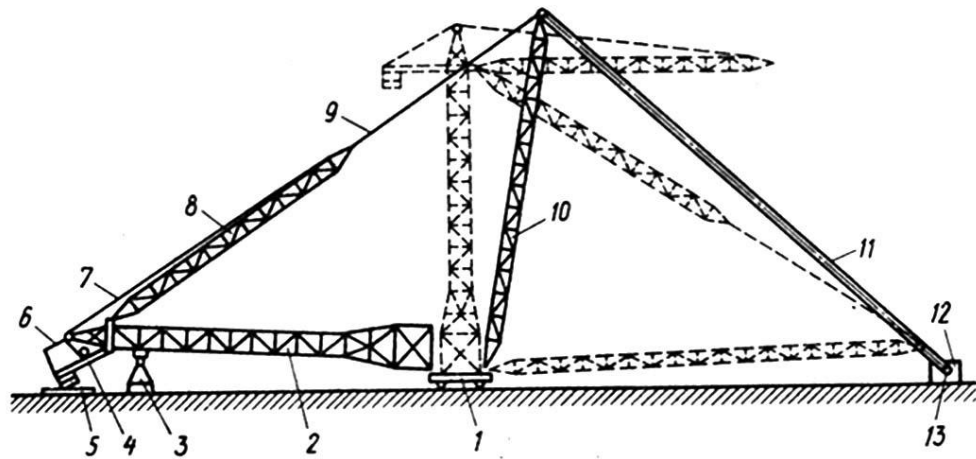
Монтаж крану з допомогою падаючої стріли
